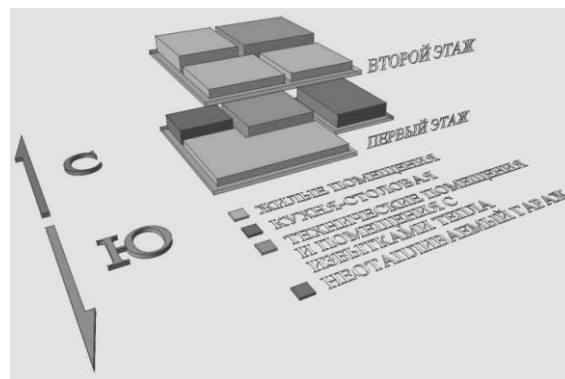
Энергосберегающее функциональное зонирование на примере двухэтажного жилого дома с гаражом.
